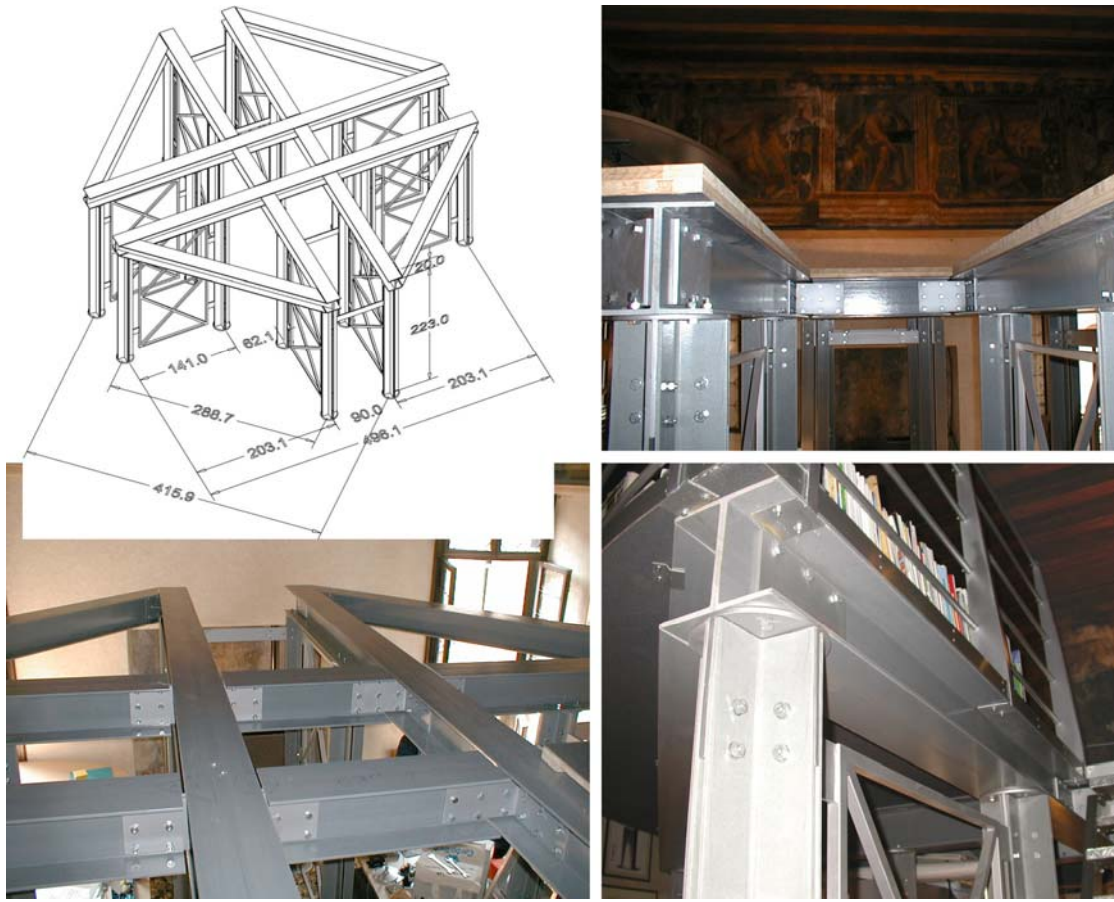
, Assonometria generale (dimensioni in cm) e dettagli (Russo 2007)
